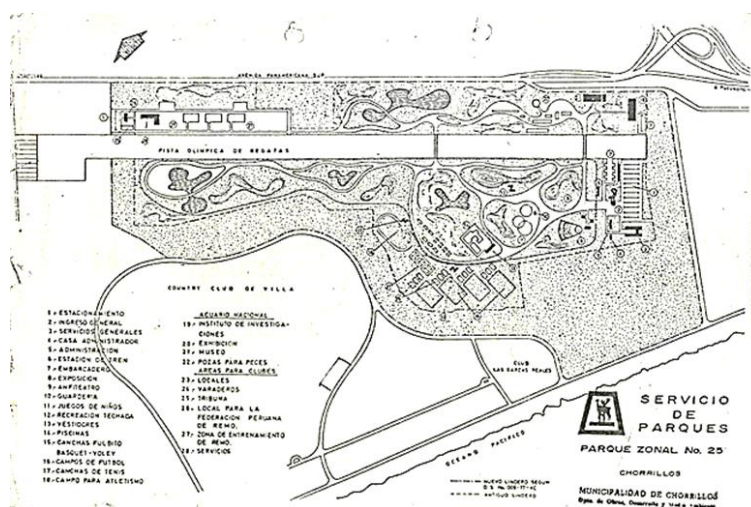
Plano Parque Metropolitano N° 25 – Villa.
